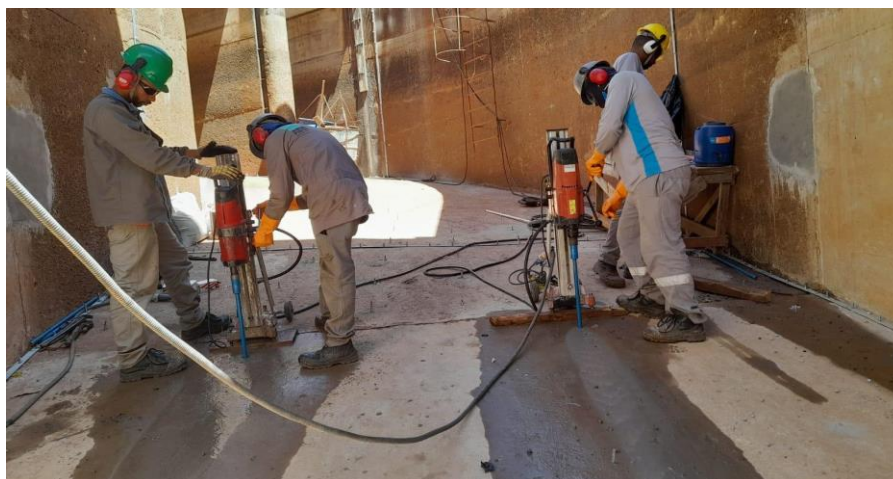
Perfuração da laje do canal para instalação de bicos de injeção (Fonte: acervo digital da Gmaia)
